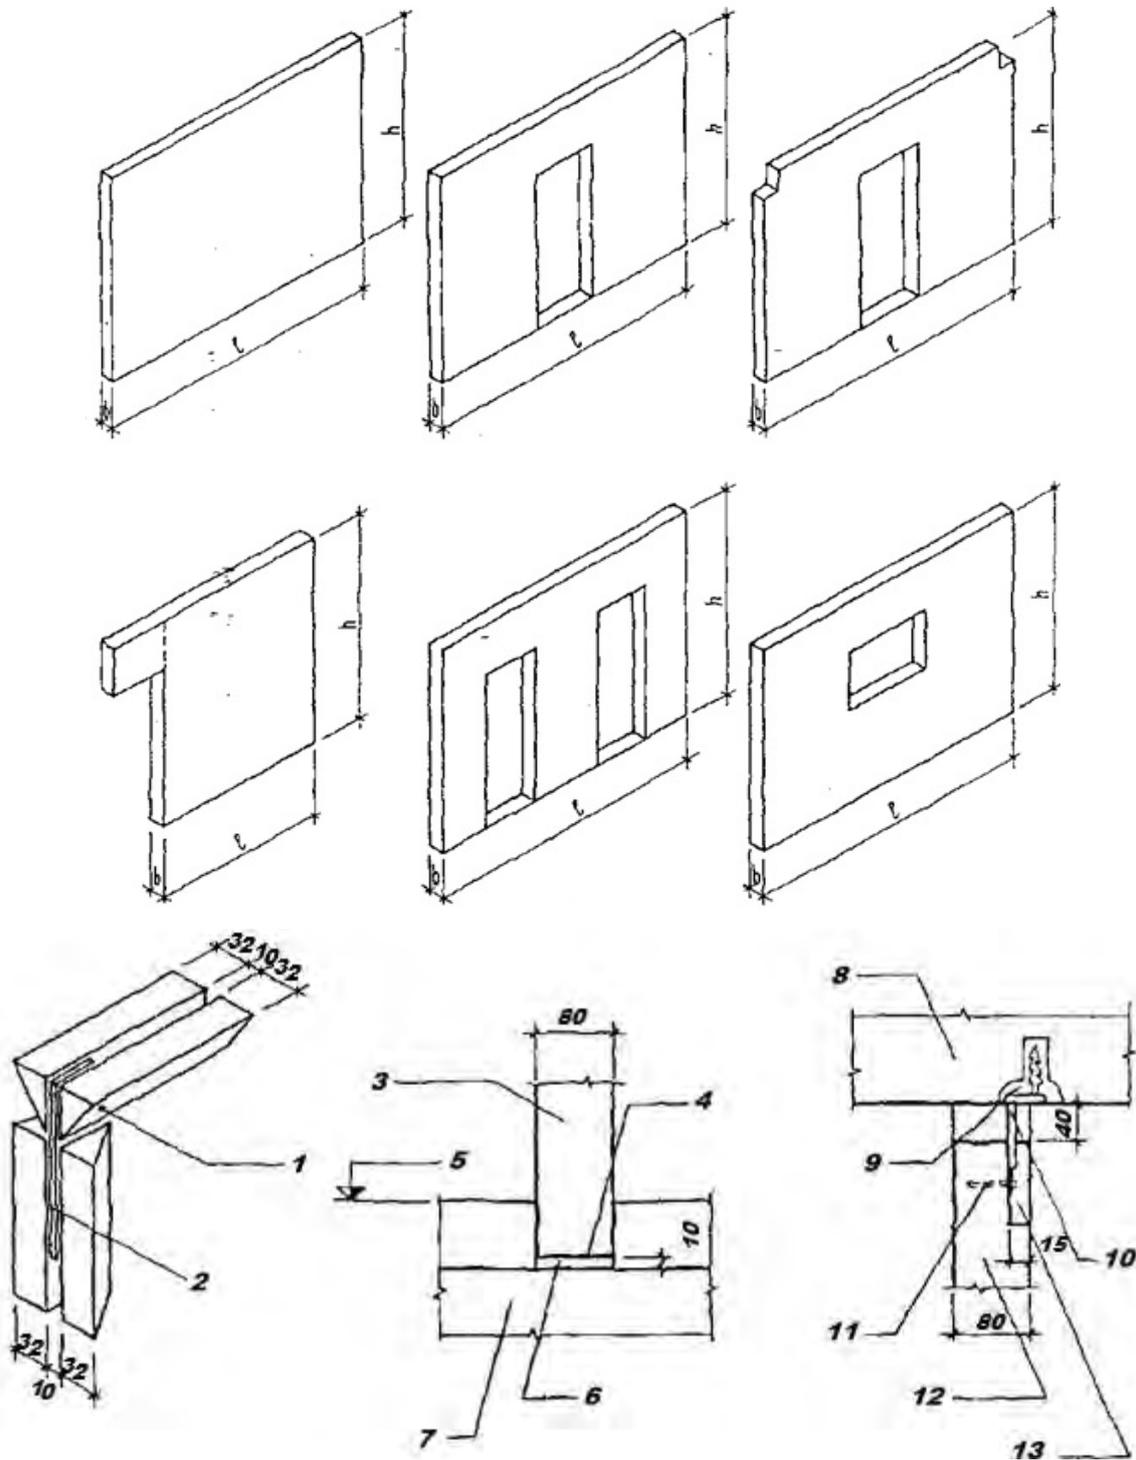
Гипсобетонные панели для перегородок и их детали: 1 — гвоздь; 2 — прокладка; 3, 12 — гипсобетонная панель; 4 — толь; 5 — уровень чистого пола; 6 — цементный раствор; 7 — панель междуэтажного перекрытия; 8 — панель перекрытия; 9 — монтажное отверстие, которое заделывается цементным раствором; 10 — ерш; 11 — гвоздь; 13 — гипсовый раствор
